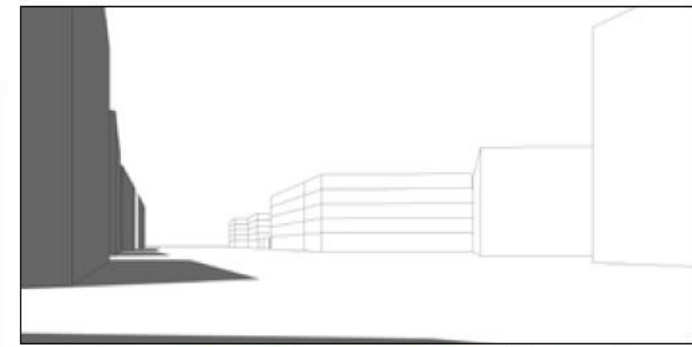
Variante 3, Perspektive Straßenraum, Blick nach Norden (1)
